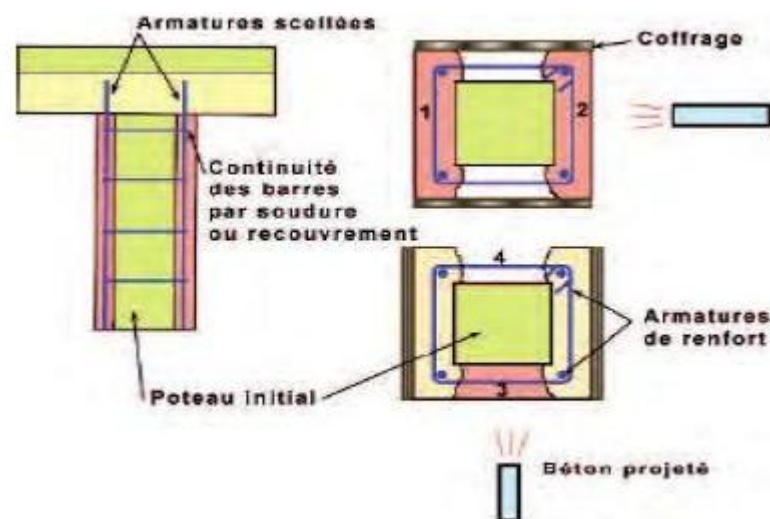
exemple de renforcement d'un poteau par ajout de béton et d'armatures.
